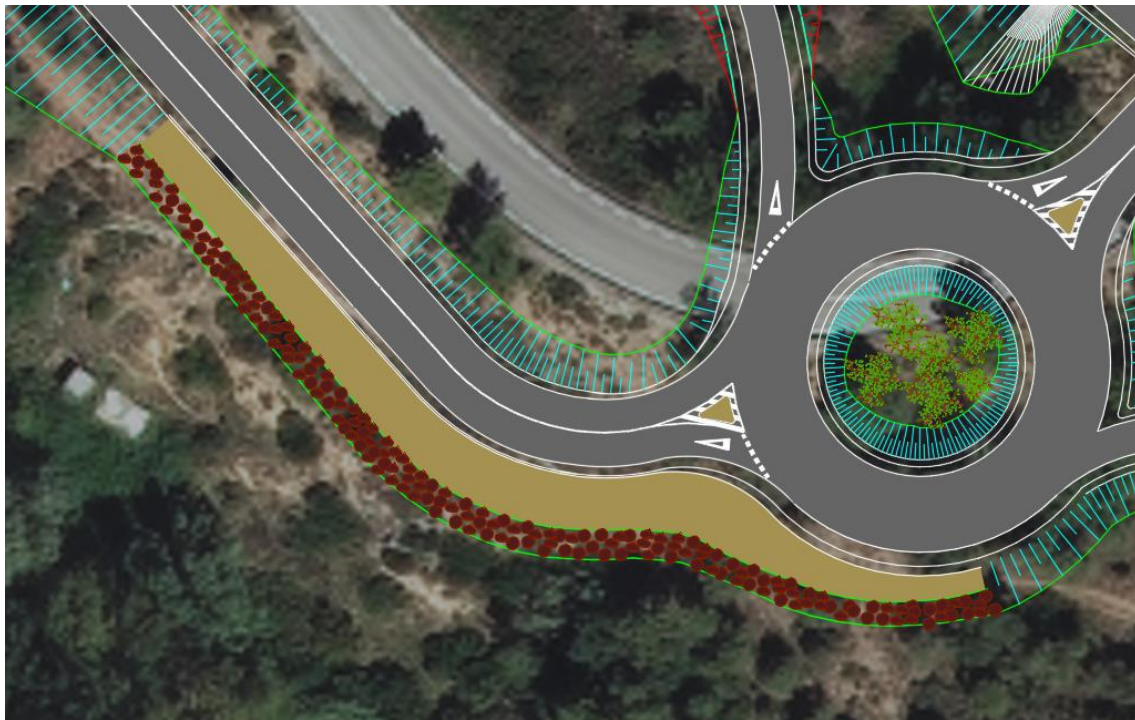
Detall en planta del tram projectat amb mur d'escullera.
